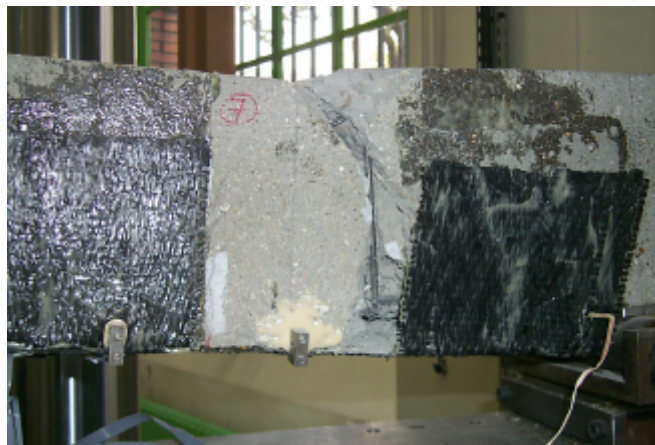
Rupture d'une poutre renforcée en mode d
